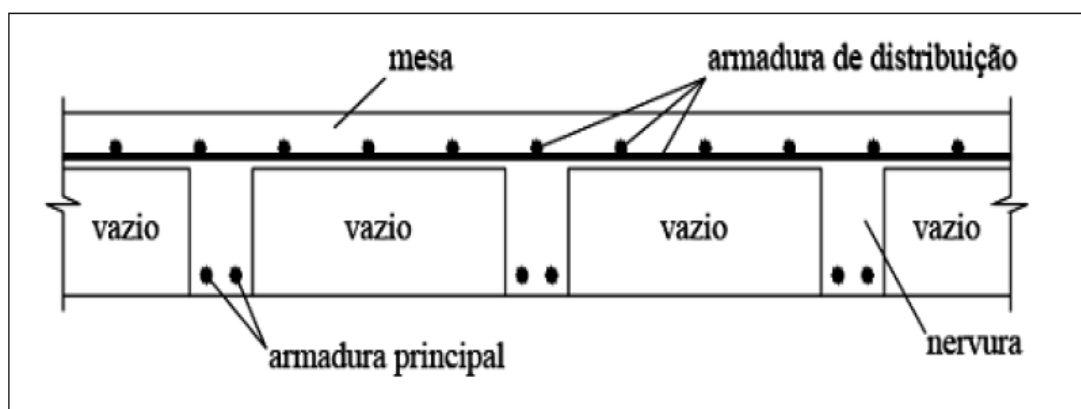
Corte transversal de uma laje nervurada com armadura (Bastos, 2005)
